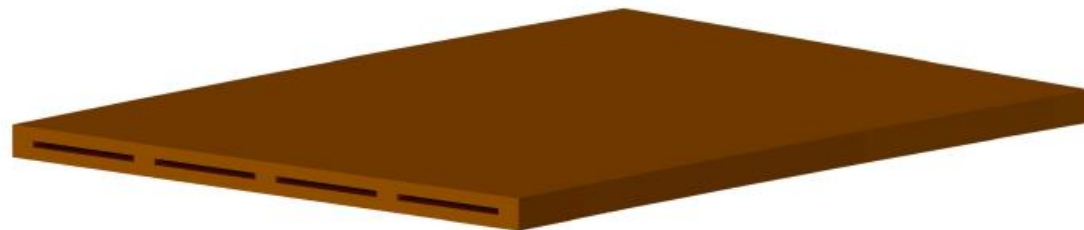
Elemento prefabricado de materiales reciclados (Fuente: elaboración propia)
